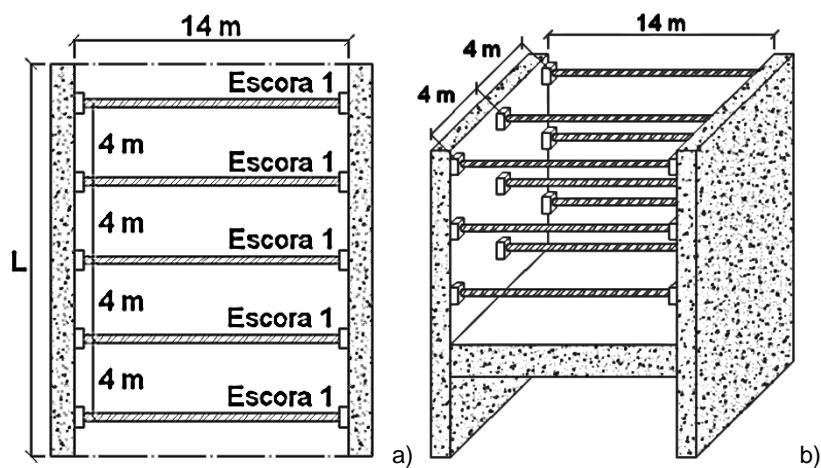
Vista em planta da escavação (a) e esquema em perspectiva (b)
